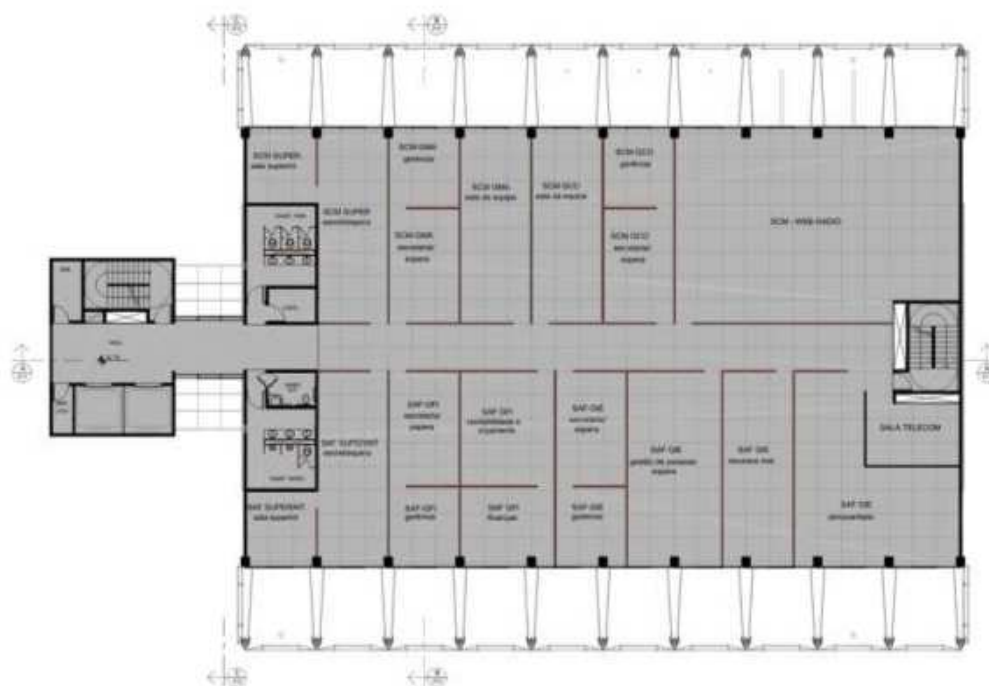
Planta Baixa | 2º Pavimento. (FONTE: SKYSCRAPERS, 2011).
